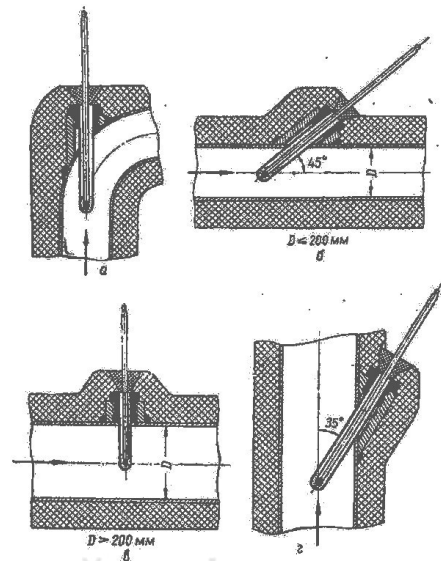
Встановлення ртутних термометрів у захисних гільзах: а – вздовж осі трубопроводу; б – похило до осі горизонтального трубопроводу; в – нормально до осі горизонтального трубопроводу; г – на вертикальному трубопроводі
